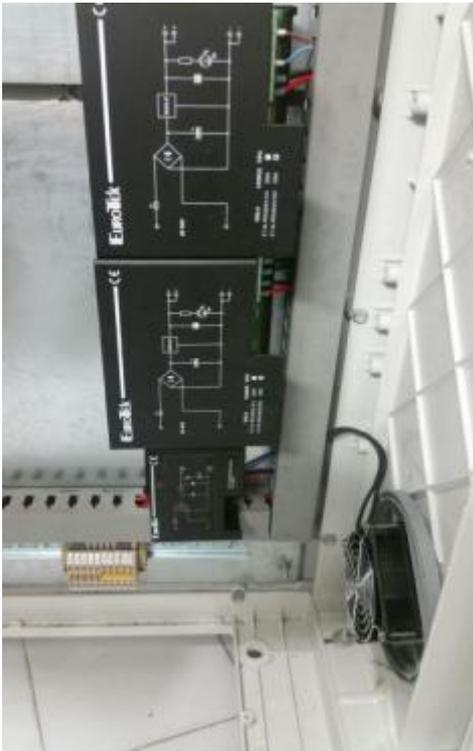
Armadio stradale cablato 5T da fornire, collegare e installare su basamento esistente
